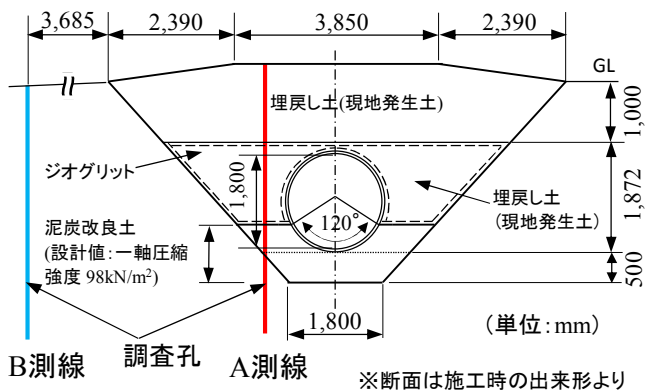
調査地点2の断面図 (改良土基礎のみタイプ)
